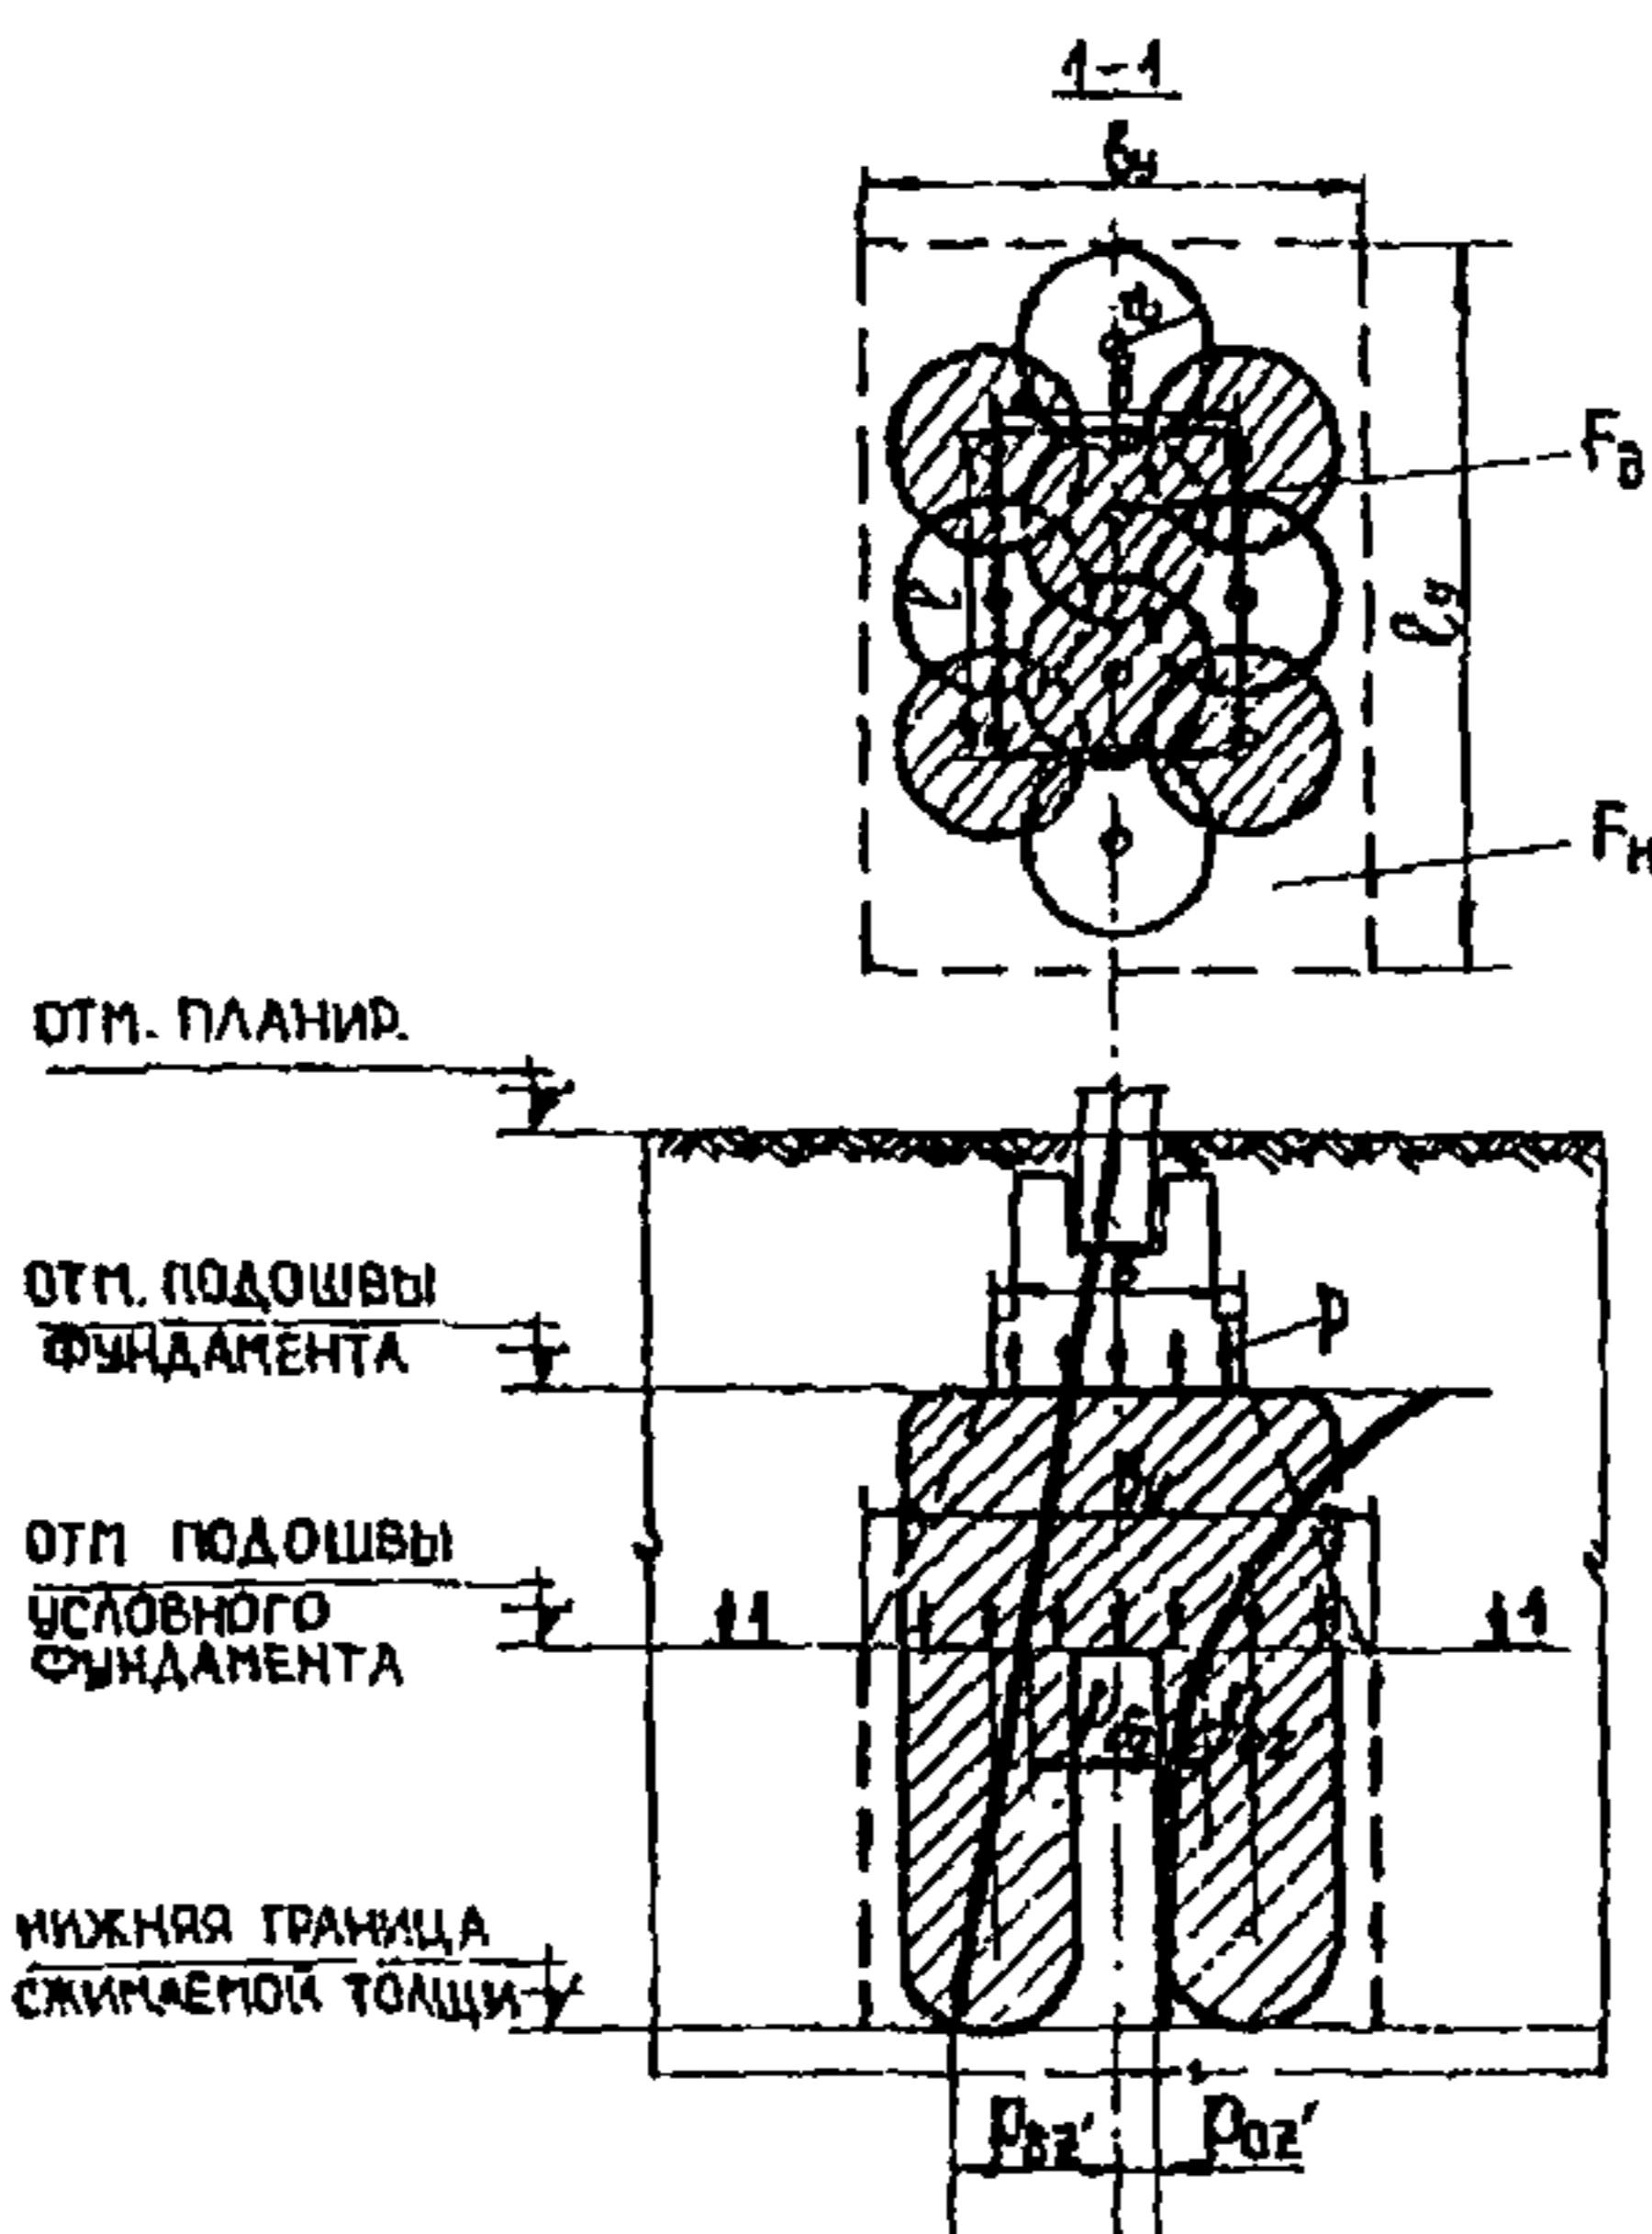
Схема к расчету осадки фундамента при комбинированном закреплении грунтов основания
